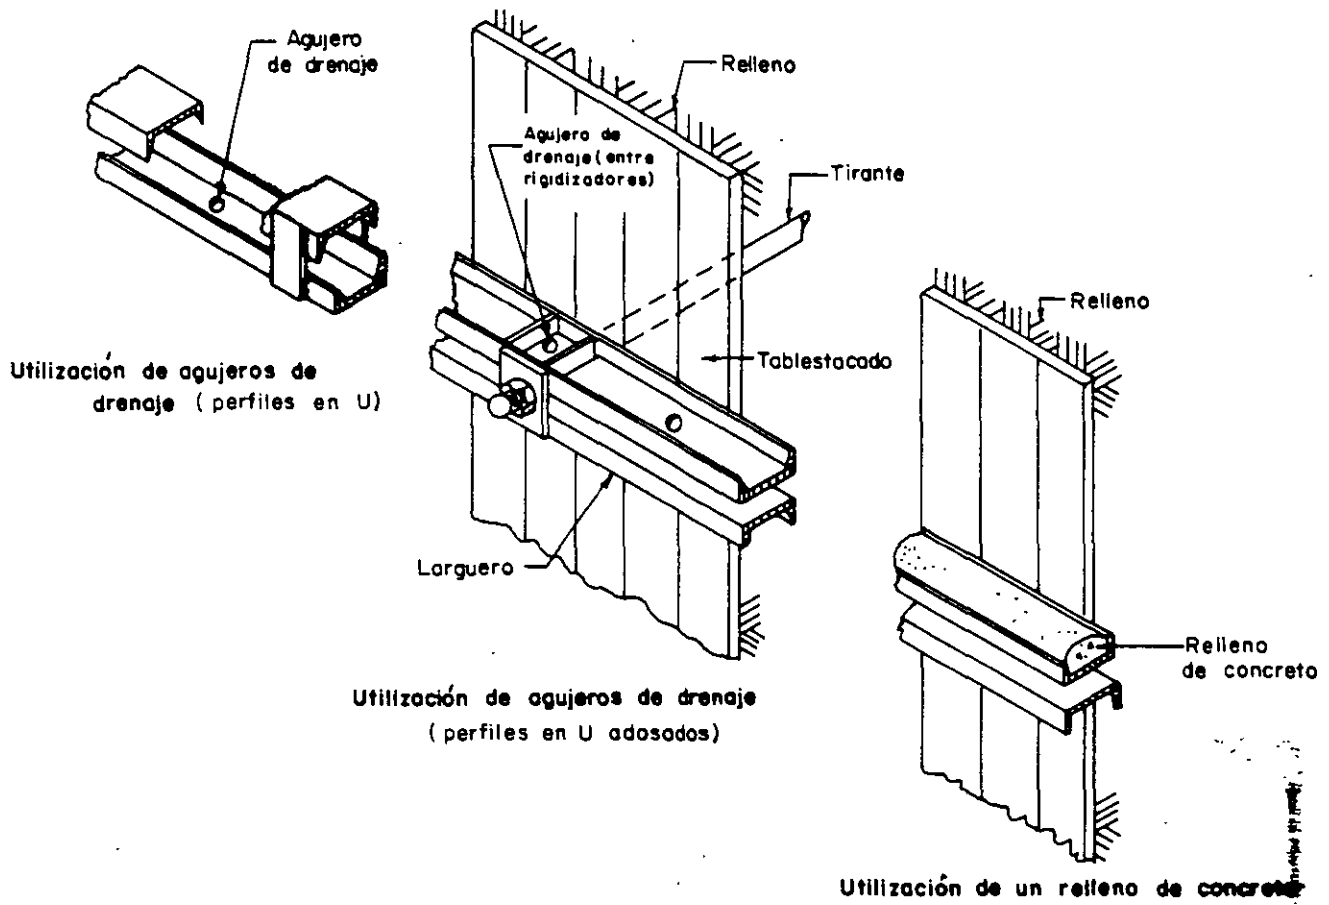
Drenajes de perfiles estructurales. El tratamiento de dobles T de ala ancha y normales es análogo.
